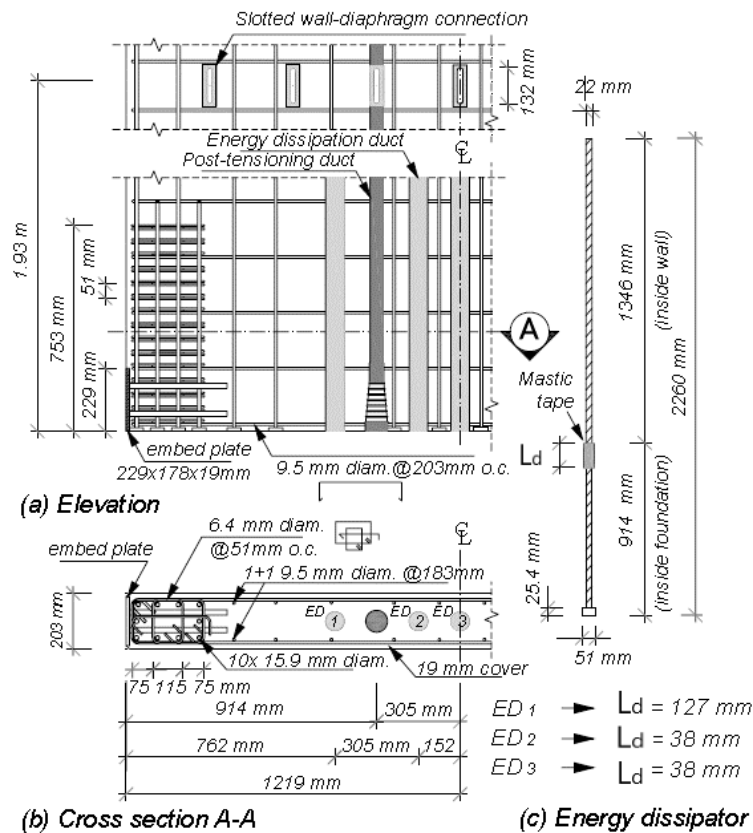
Prospetto (a), sezione longitudinale (b) e geometria dei dissipatori isteretici (c) presenti all'interno della parete rocking (Belleri, et al., 2014). / Elevation (a), cross-section (b) and geometry of the dissipative devices (c) in the rocking wall (Belleri et al., 2014).
